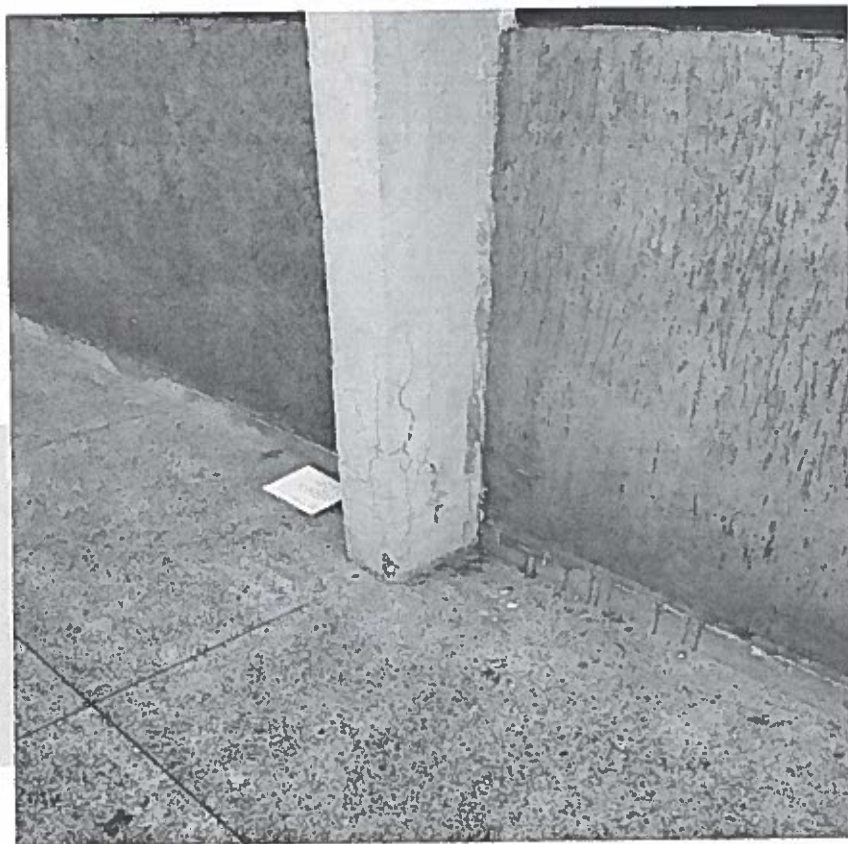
Pilar 66 – Rachadura vertical na base do pilar
